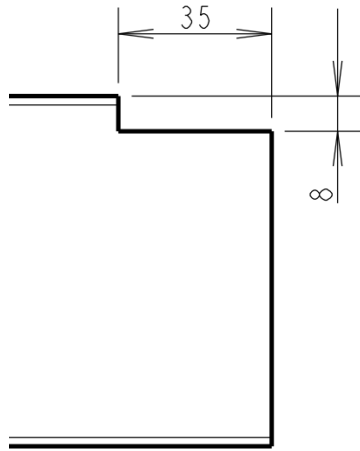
Corte de ala de vigas de acero A36 UPN 80
